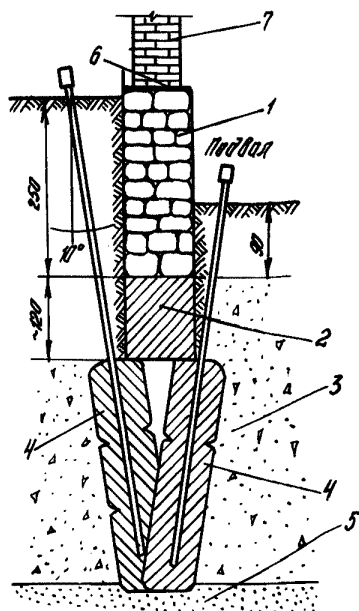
Разрез по закрепленному грунту под фундаментами:
